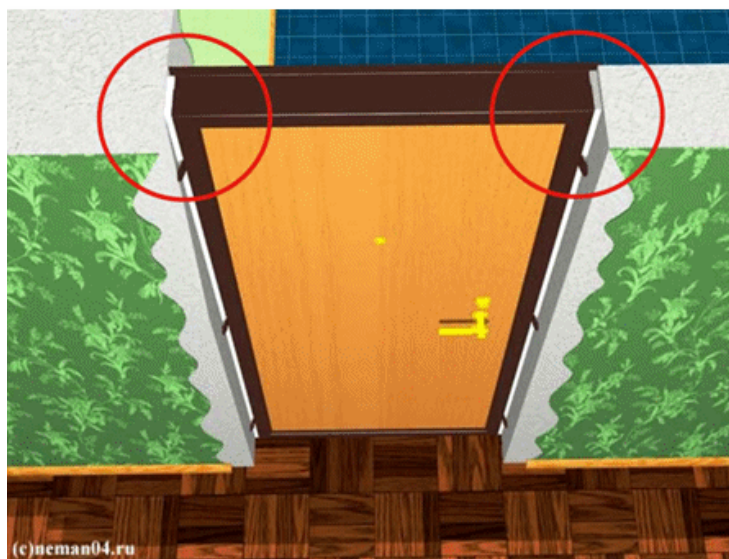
Схема установки металлической двери в проем железобетонной стены разной толщины, слева по типу А-1, справа по типу Б-1
